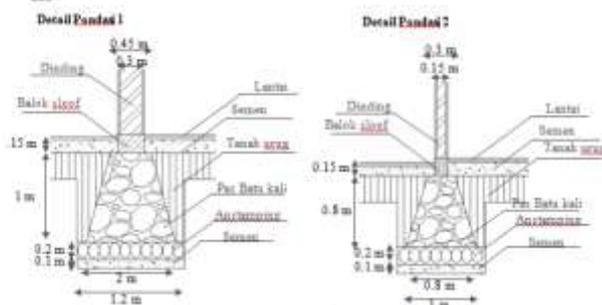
Konstruksi dinding penopang bangunan stasiun Kediri
